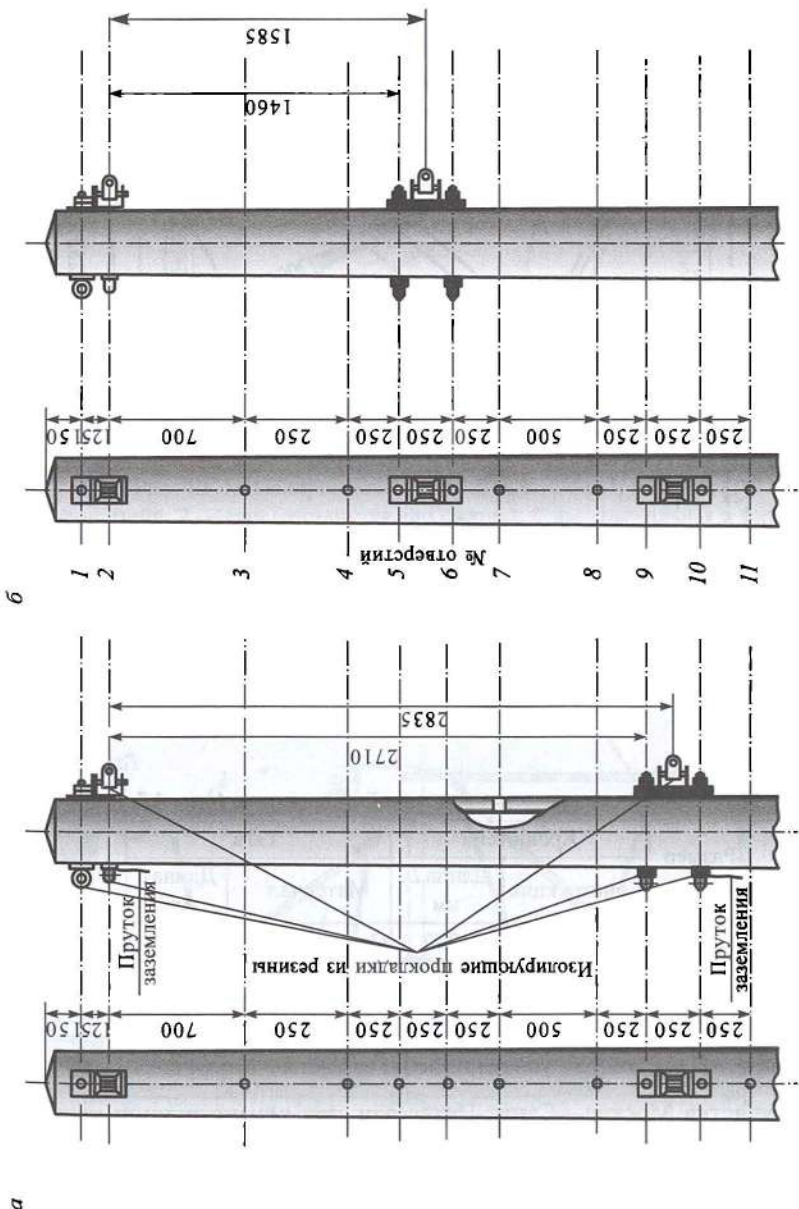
Схема расположения закладных деталей на железобетонной опоре длиной 13,6 и 10,8 м для крепления наклонных (а) и изогнутых (б) консолей
